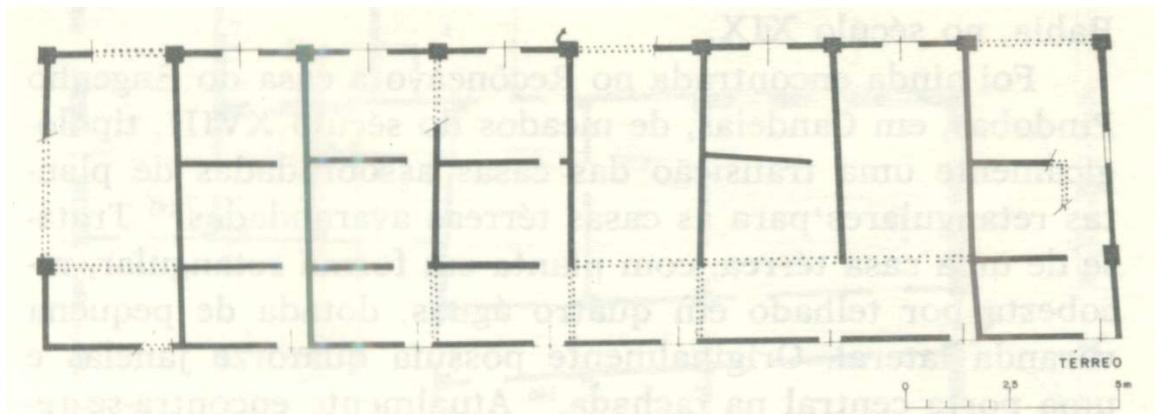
Planta Baixa. Compartimentos de, aproximadamente 3,0 m x 2,5m.
